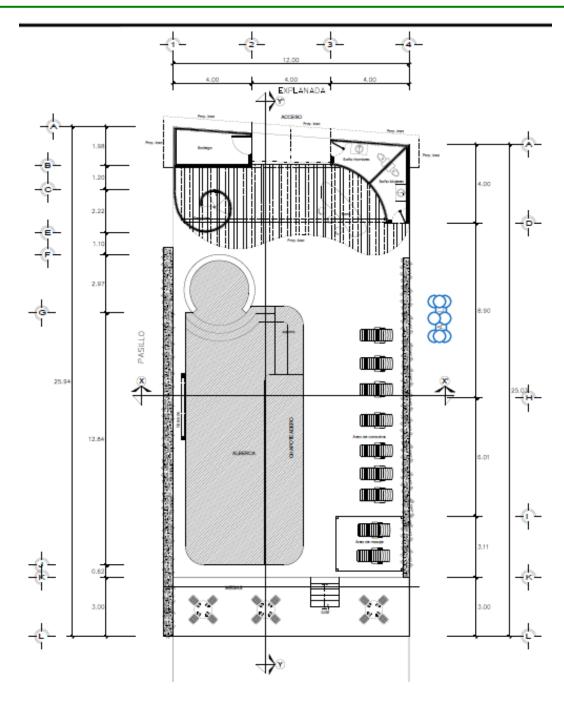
Planta arquitectónica del club de playa Rockaway.
